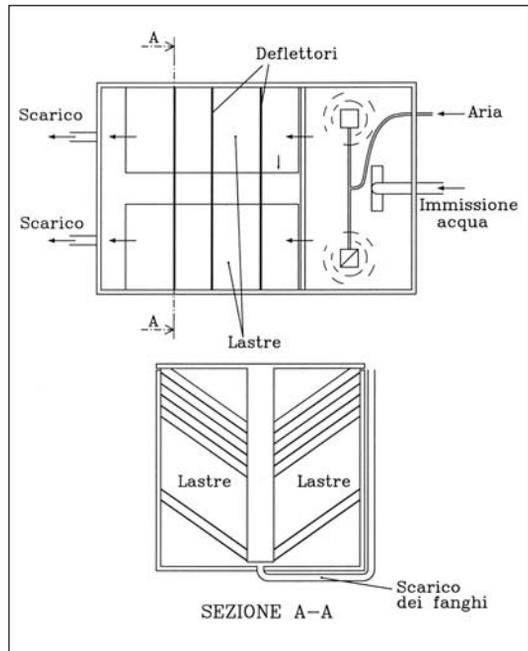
Schema di decantatore lamellare; pianta e sezione.
